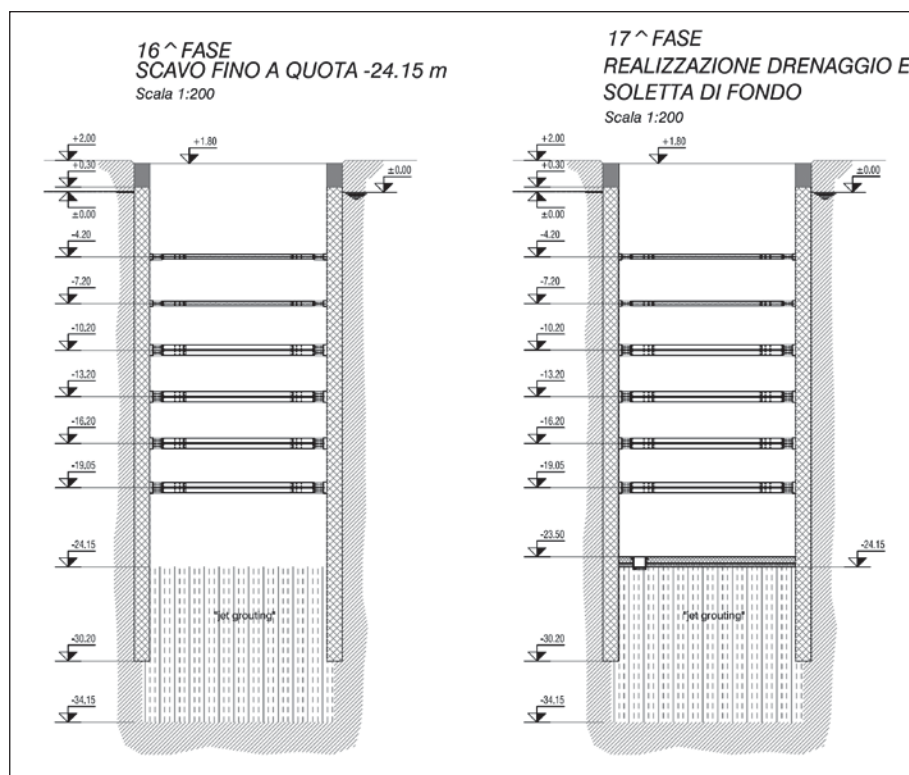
/B – Rappresentazione delle due ultime fasi di costruzione di un pozzo (Progetto del microtunnel di attraversamento del Canale Industriale nel Porto di Livorno)
